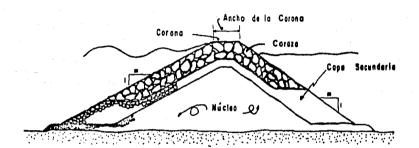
OBRAS DE TALUD, SECCION TIPO.
